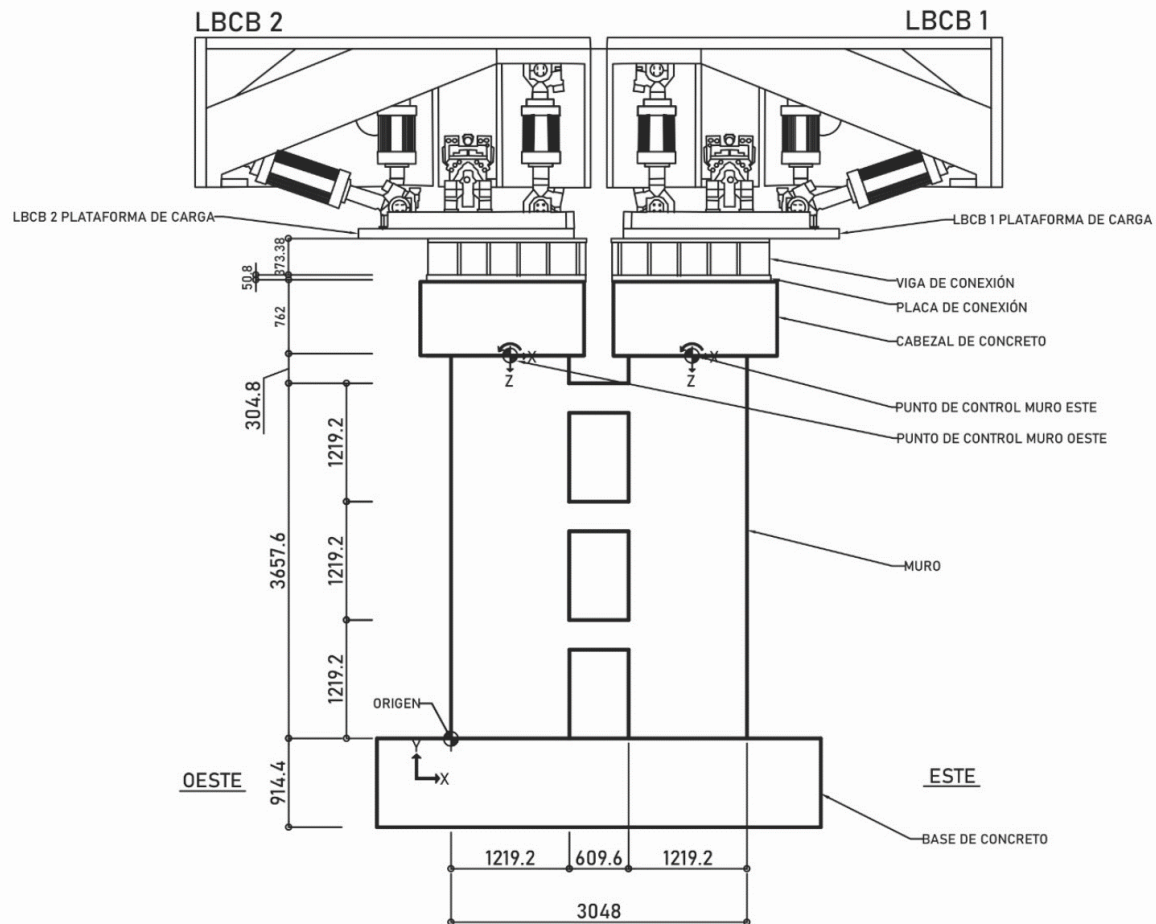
Características geométricas y detalle de armado del sistema de muros acoplado ensayado por (Turgeon, 2011)
